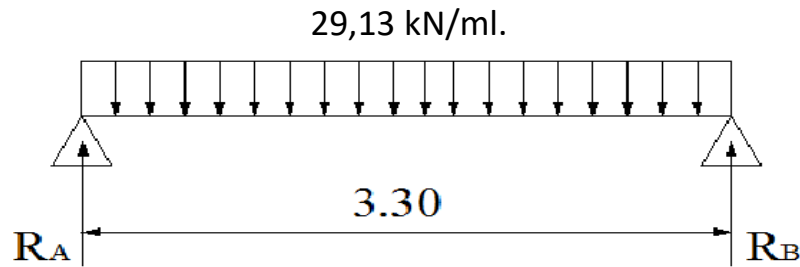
Schéma statique de la poutre à l'ELS.
